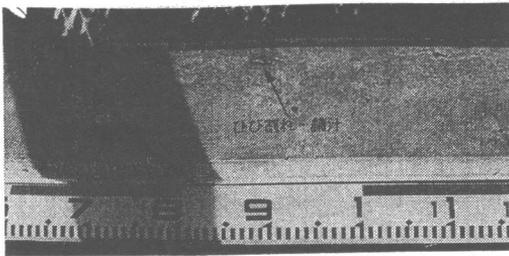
ひび割れ状況 (No.1-2,12カ月)
